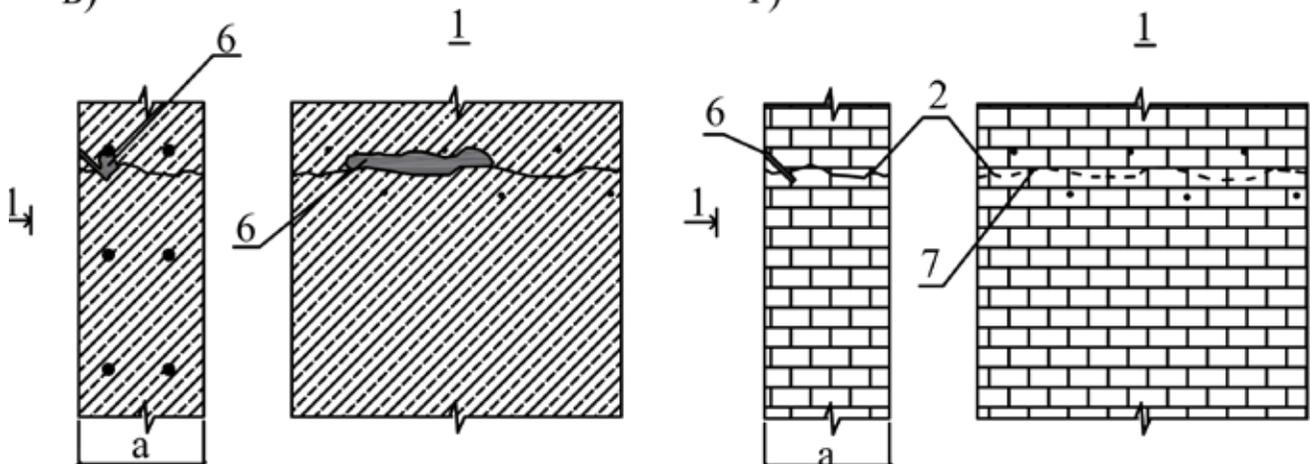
Схема заполнения статичных трещин и пустот в монолитной бетонной или кирпичной стене
